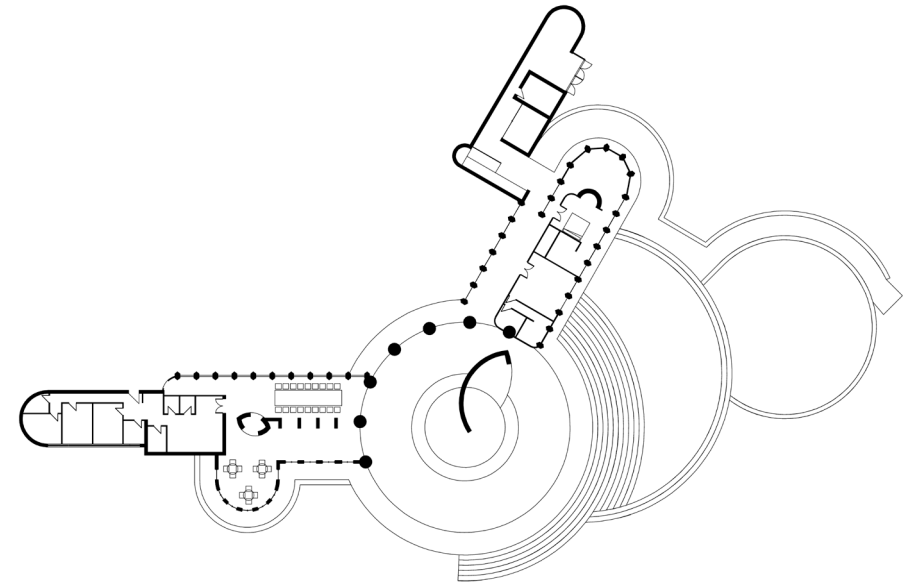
Casa Baillères. Planta baja. Acapulco, 1952. Dibujado a partir de los planos originales.
